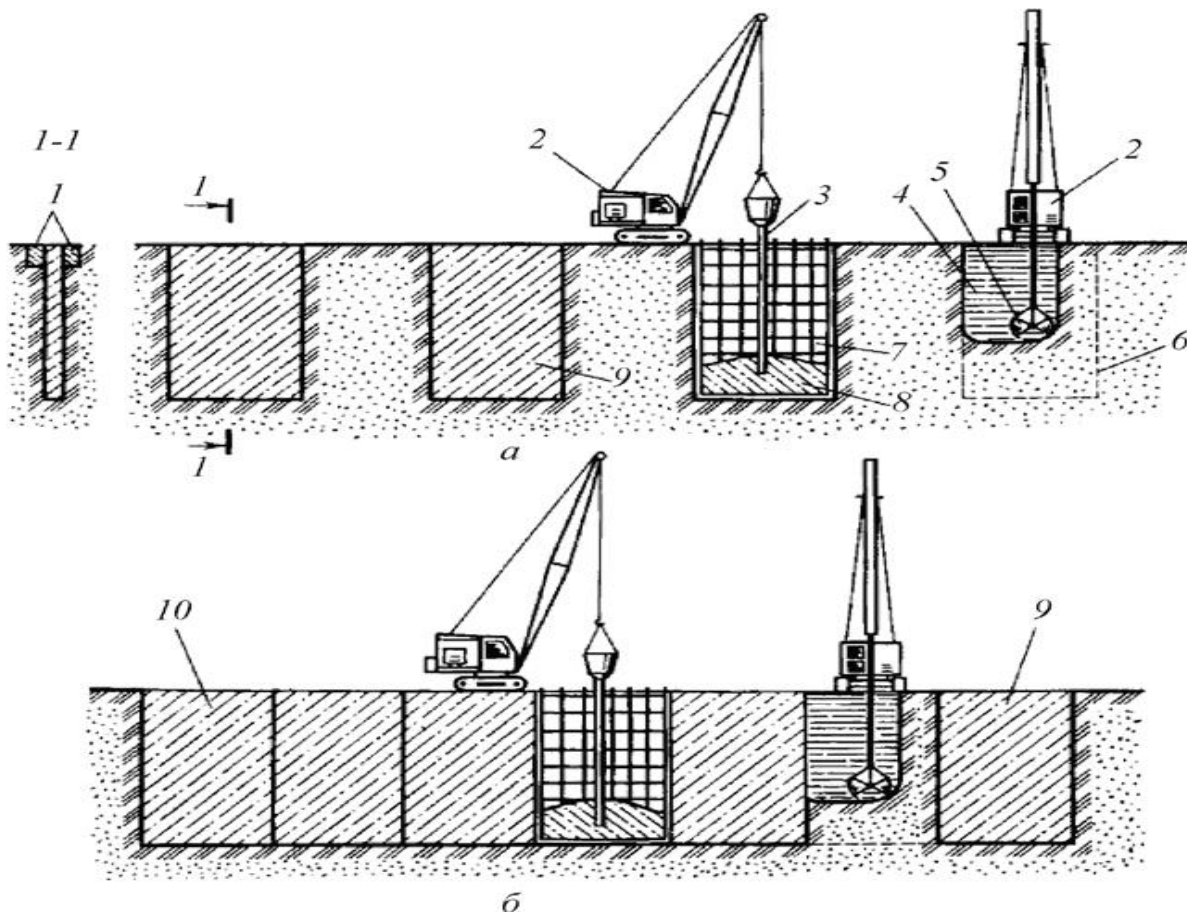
Послідовність робіт під час будівництва підземних споруд способом «стіна в ґрунті»: а) перша черга робіт; б) друга черга робіт; 1 – форшахта; 2 – базовий механізм; 3 – труба для заливання бетону; 4 – глинистий розчин; 5 – грейфер; 6 – траншея під одну захватку; 7 – арматурний каркас; 8 – бетонна суміш; 9 – забетонована секція; 10 – готова секція «стіна в ґрунті»
